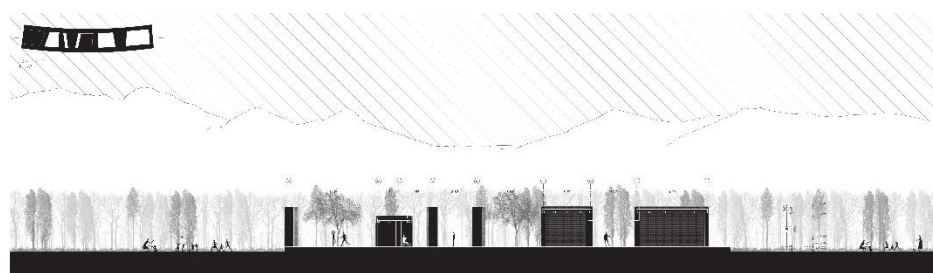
Corte 1-1' Pabellón de apoyo tipo III
